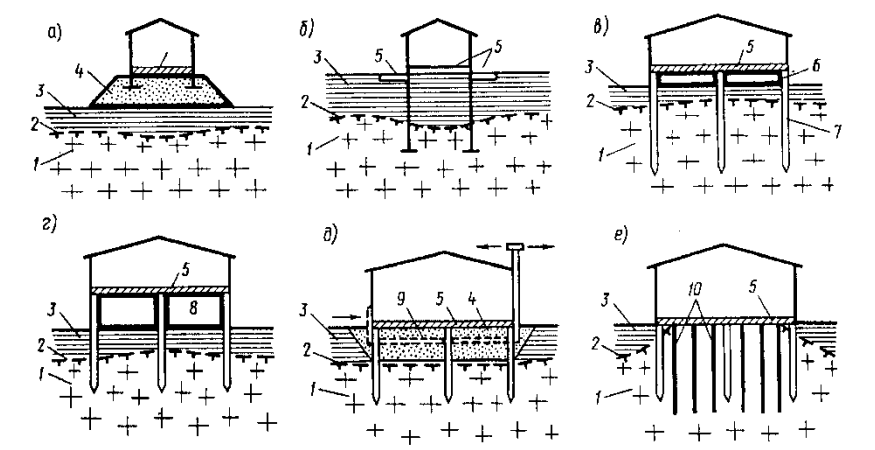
Мероприятия для сохранения вечно мерзлого состояния грунтов:
